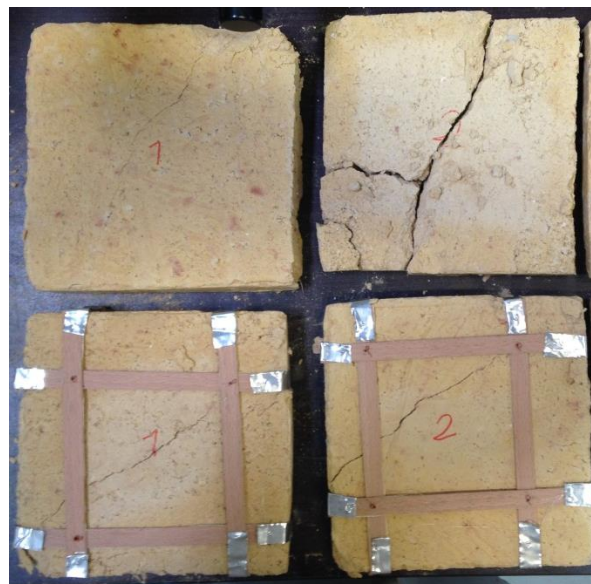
Fisuras presentadas en los muretes por tracción diagonal
